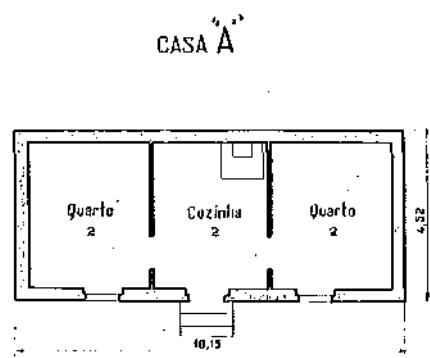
Planta do Edifício Casa “A”. Adaptado do Anexo VI. 1952<sup>365</sup>
